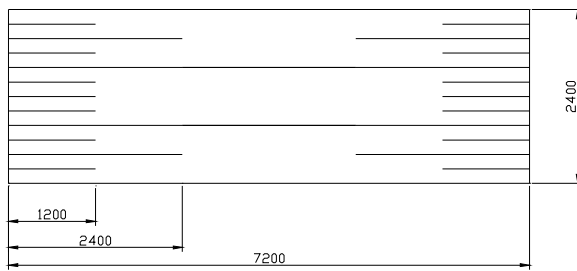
Bovenaanzicht met verdeling perfobonds over het paneel
